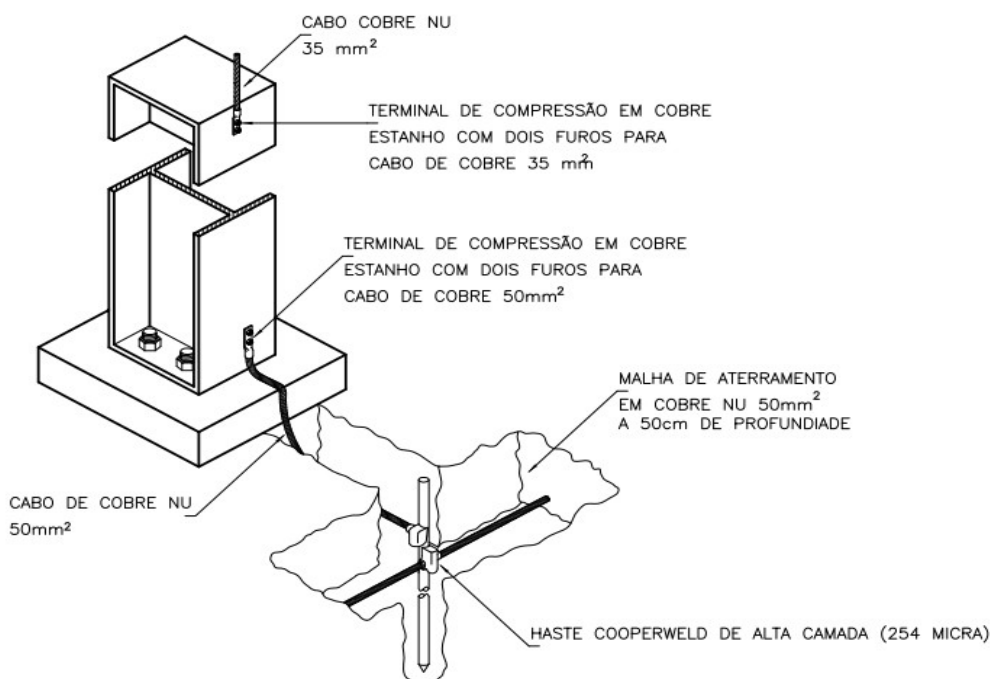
Detalhe de fixação do cabo de cobre nu de 35 mm² no pilar. Utilizar terminais nas 02 pontas (na telha/terça e no pilar)
